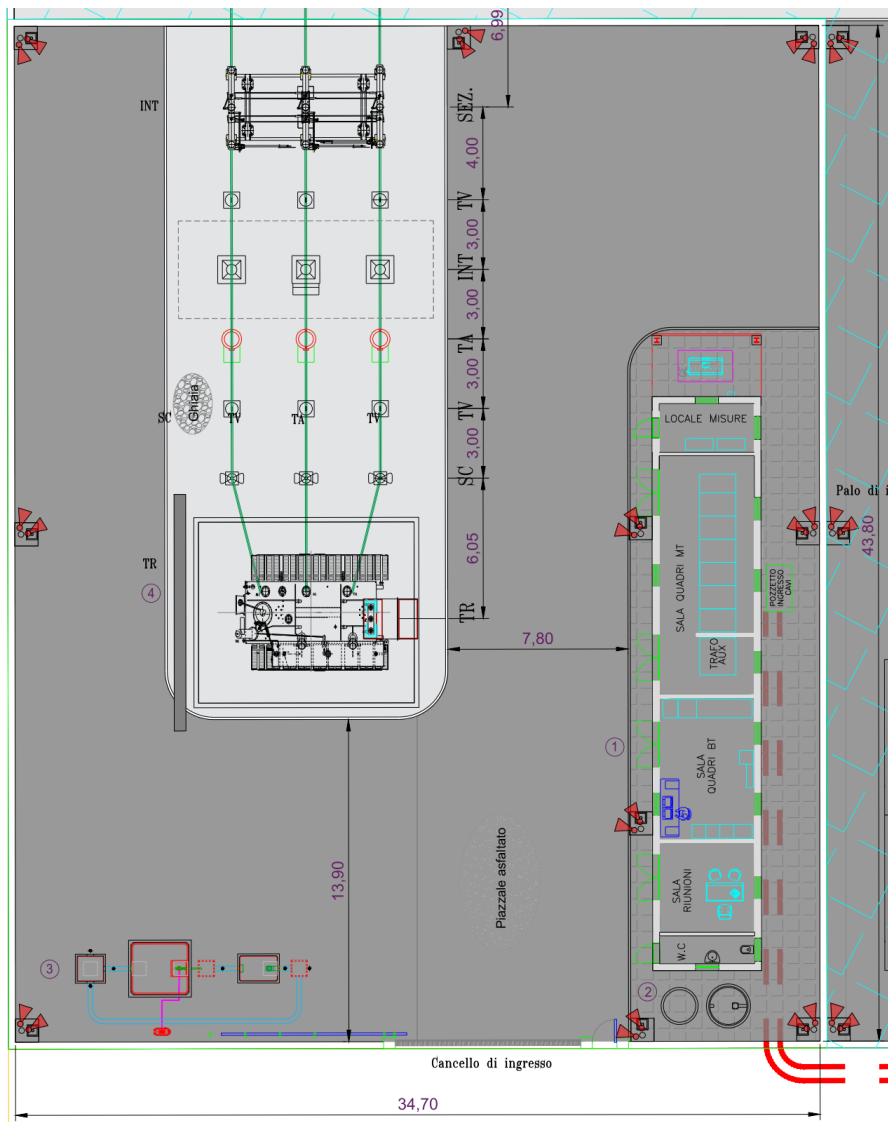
Planimetria elettromeccanica stazione utente 220/30 kV
